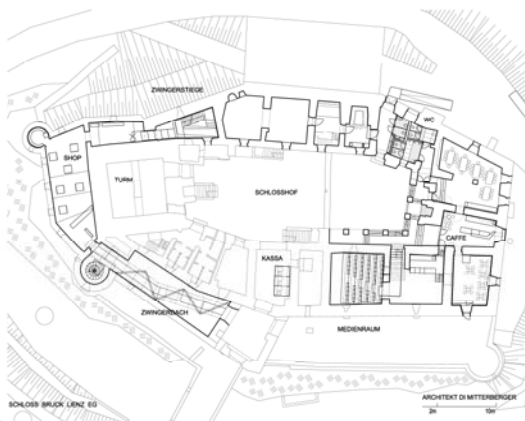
Schloss Bruck, Grundriss, Erdgeschoss
